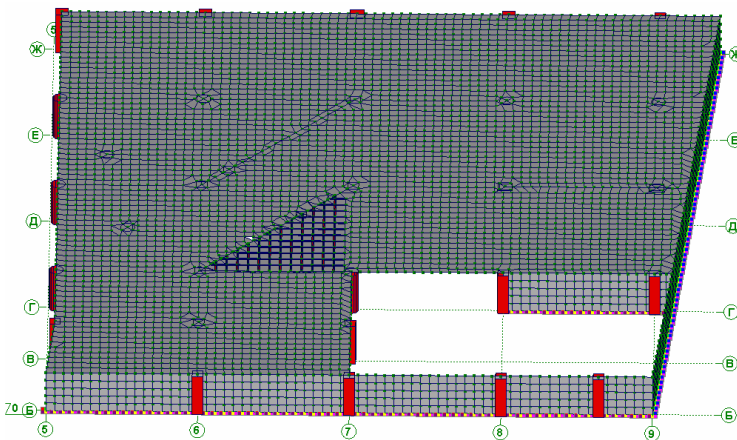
Расчетная модель перекрытия с включением треугольной зоны, поврежденной пожаром
